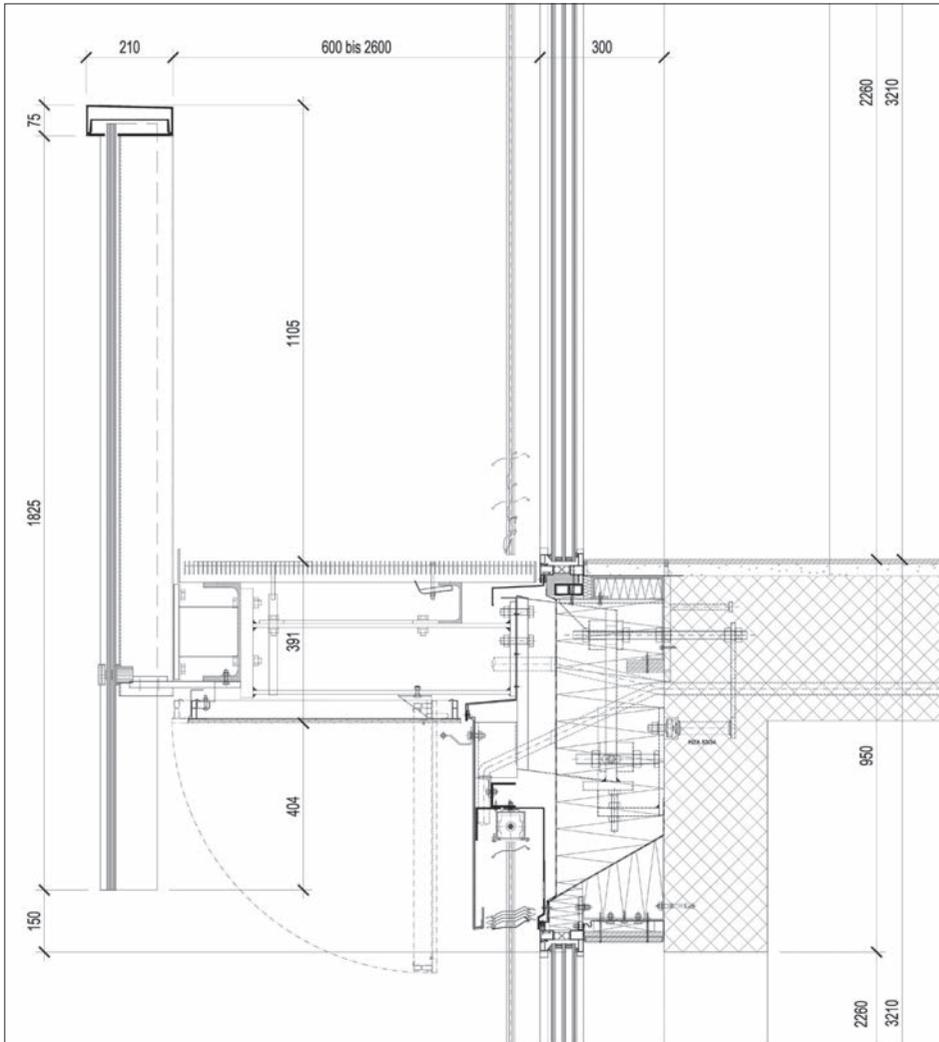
Vertikalschnitt: Serviceschicht und Deckenstirn mit Fensteranschluss unten und oben.
